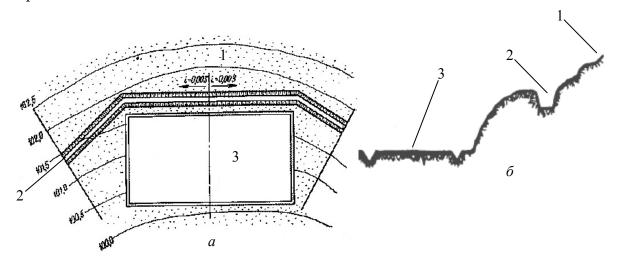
Схема временного водоотвода: а – вид в плане; б – вид в разрезе; 1 – бассейн стока воды; 2 – нагорные канавы; 3 – строительная площадка
